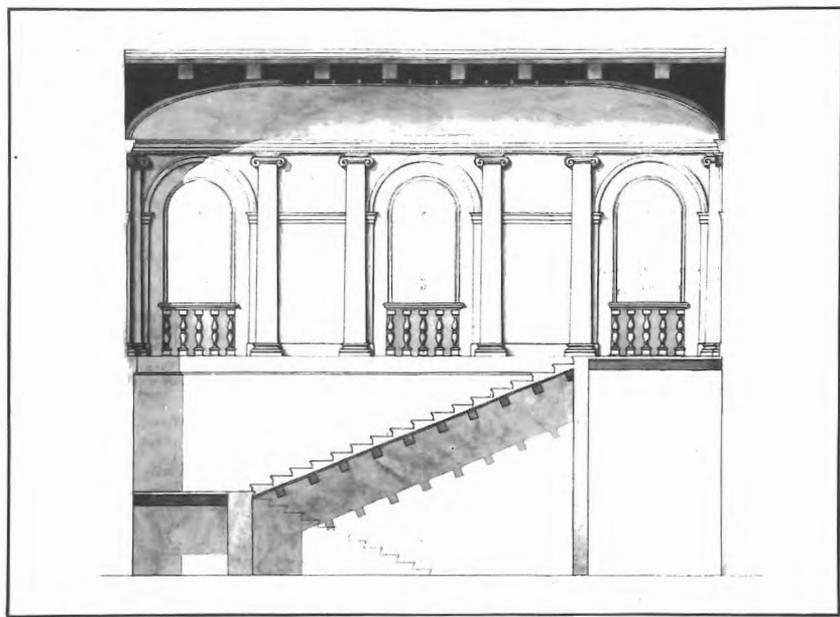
Progetto di realizzazione dello scalone di accesso alla Sala Lapidaria promosso dall'arcivescovo Chiarissimo Falconieri nel 1838. Prospetto parete sud (BSF, *Fondo Piancastelli, Carte Romagna*, busta 223).
